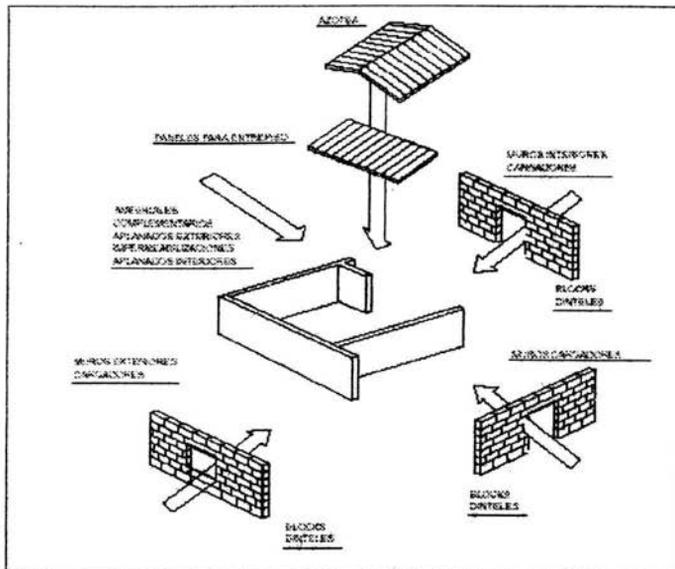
Sistema constructivo para proyectos habitacionales de concreto celular, compuesto de muros cargadores, muros interiores y paneles de losa.
